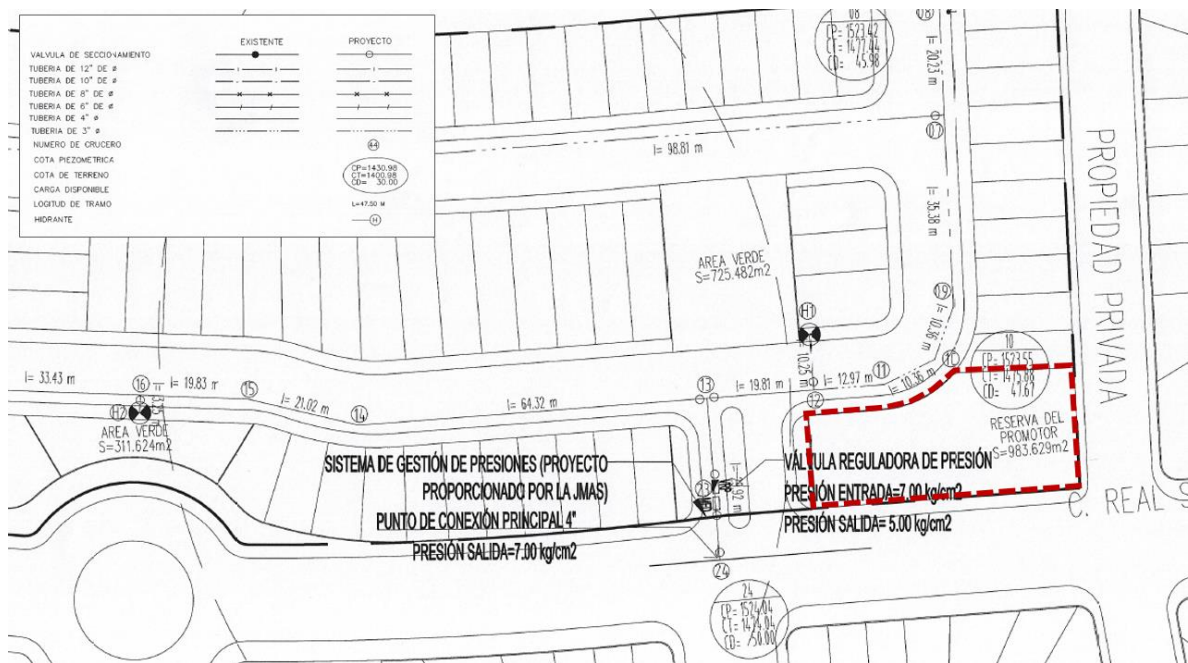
Detalle de plano de Red de Agua Potable Autorizado por JMAS. 4 septiembre 2024.
